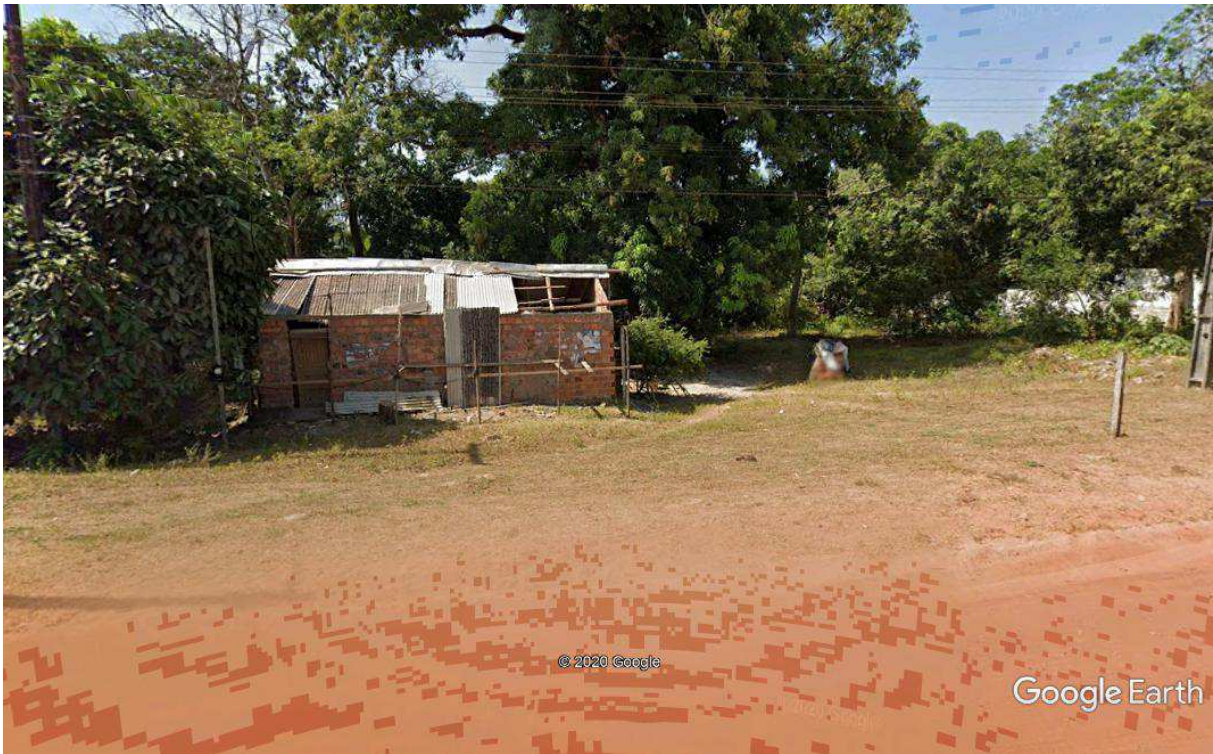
Vista da construção inabitada no interior do imóvel avaliando
